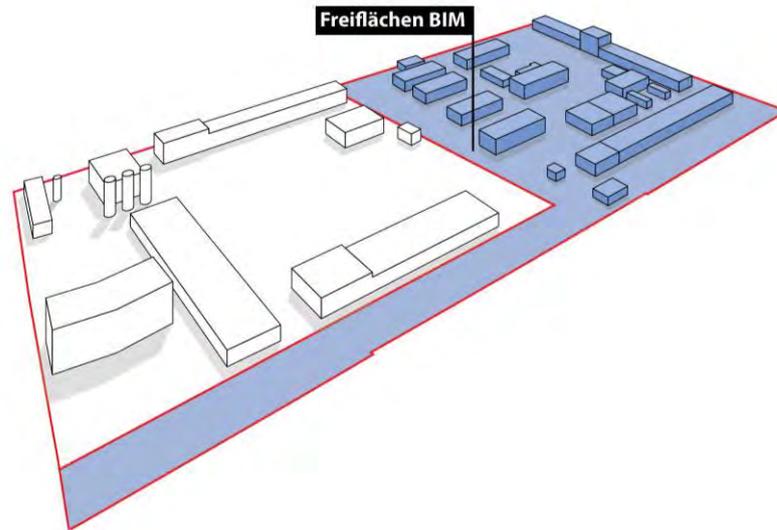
Übersichtplan Freiflächen BIM Kleingewerbe (Blau)
